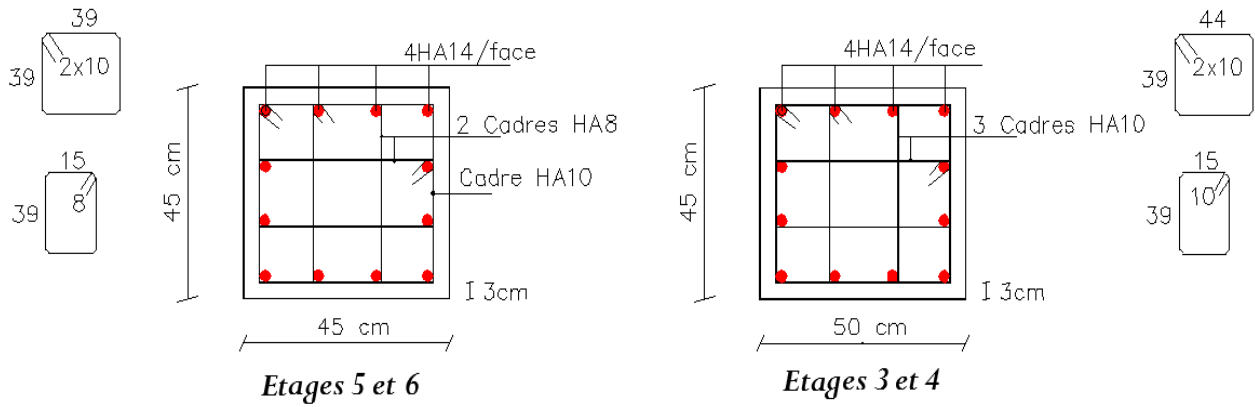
Schéma de ferrailage des poteaux d'étages 3 à 6
